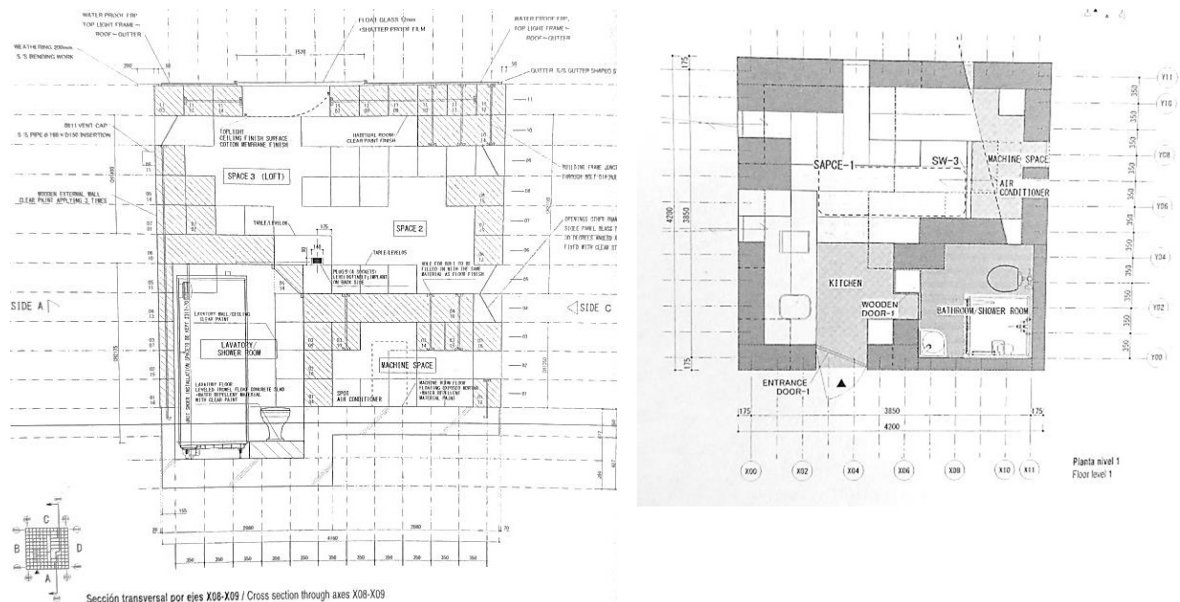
Corte pelo eixo X08-X09, e Planta nível 1
